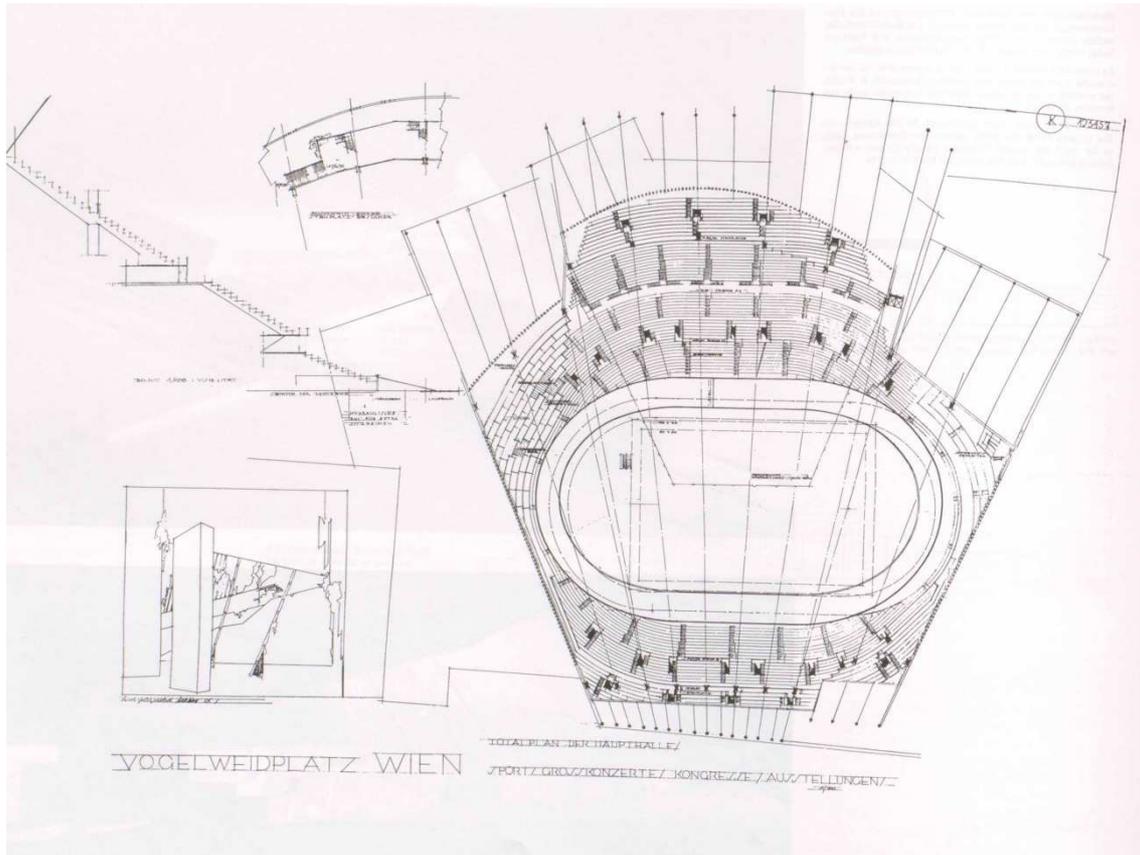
Grundriss, Detail Stahlseilverankerungen
